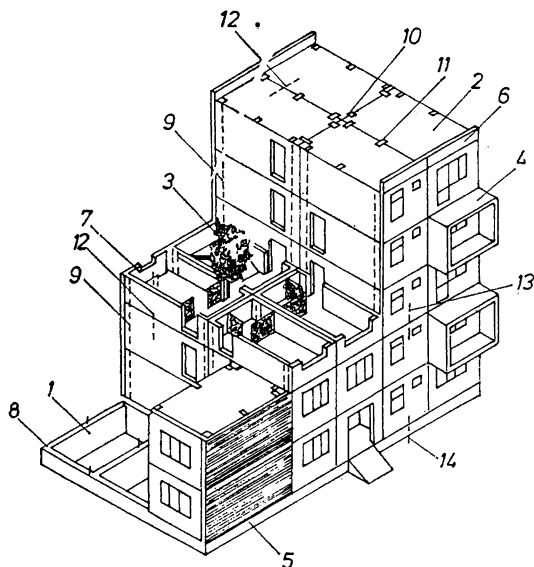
Schema structurală a unei construcții din elemente spațiale:
